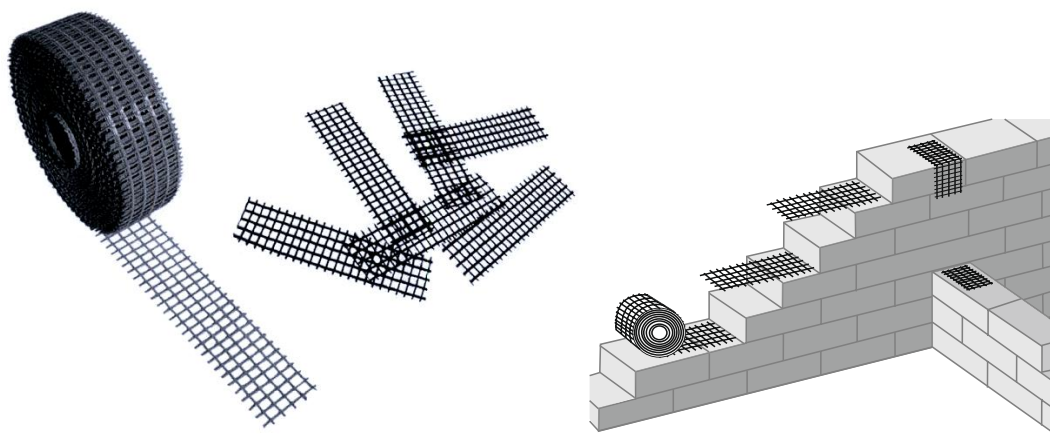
Арматурные сетки из композитных материалов для армирования тонких горизонтальных растворяемых швов [27,30]
